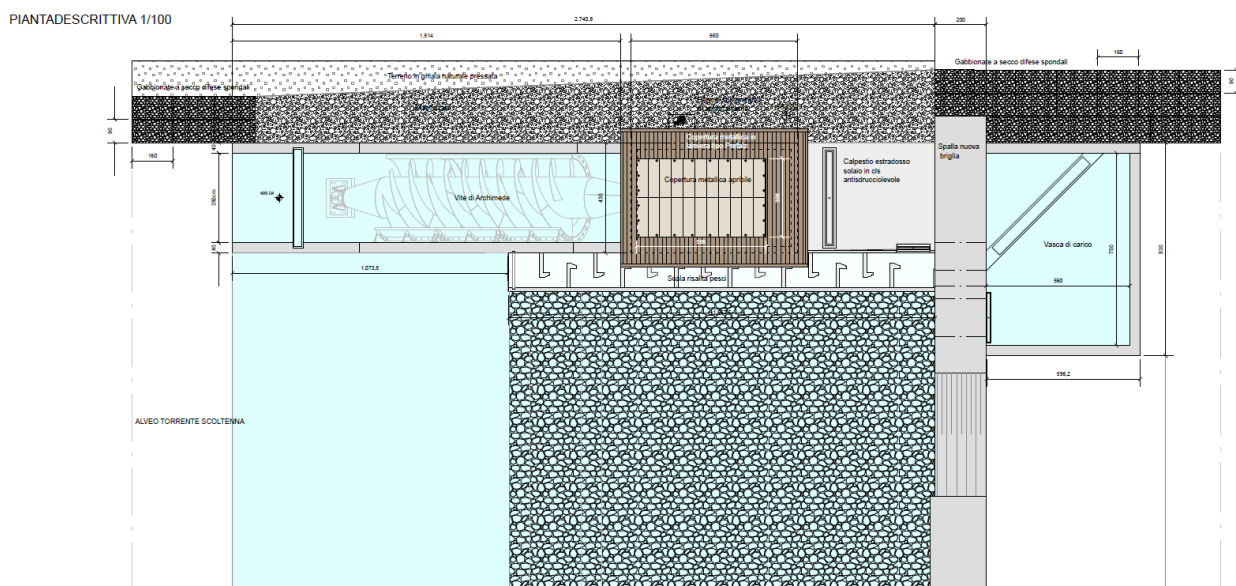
Planimetria di progetto del manufatto e delle opere accessorie
